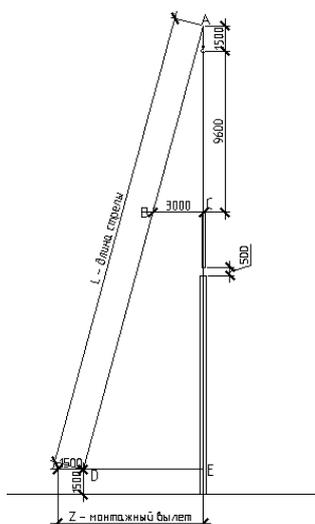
Схема к выбору крана для монтажа ферм покрытия
